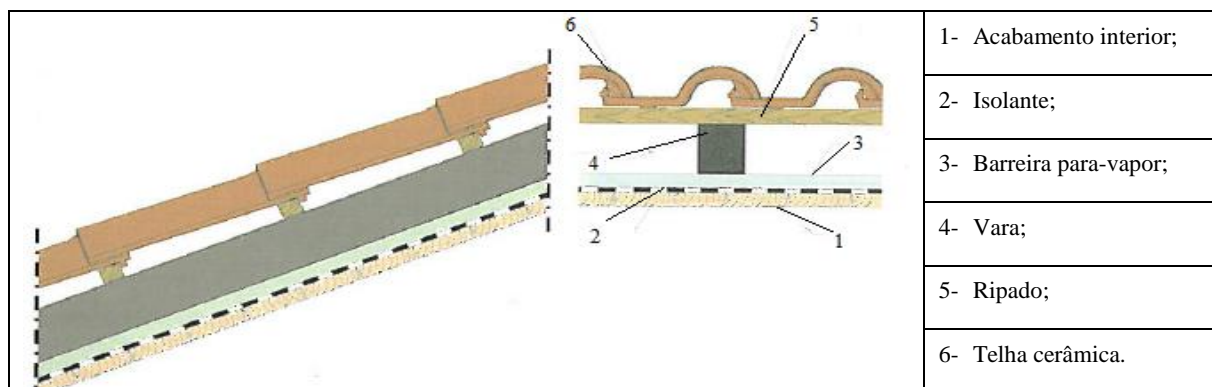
Cobertura inclinada em telha cerâmica, assente em estrutura de madeira com desvão habitável e colocação de isolamento na face inferior da estrutura cobertura
